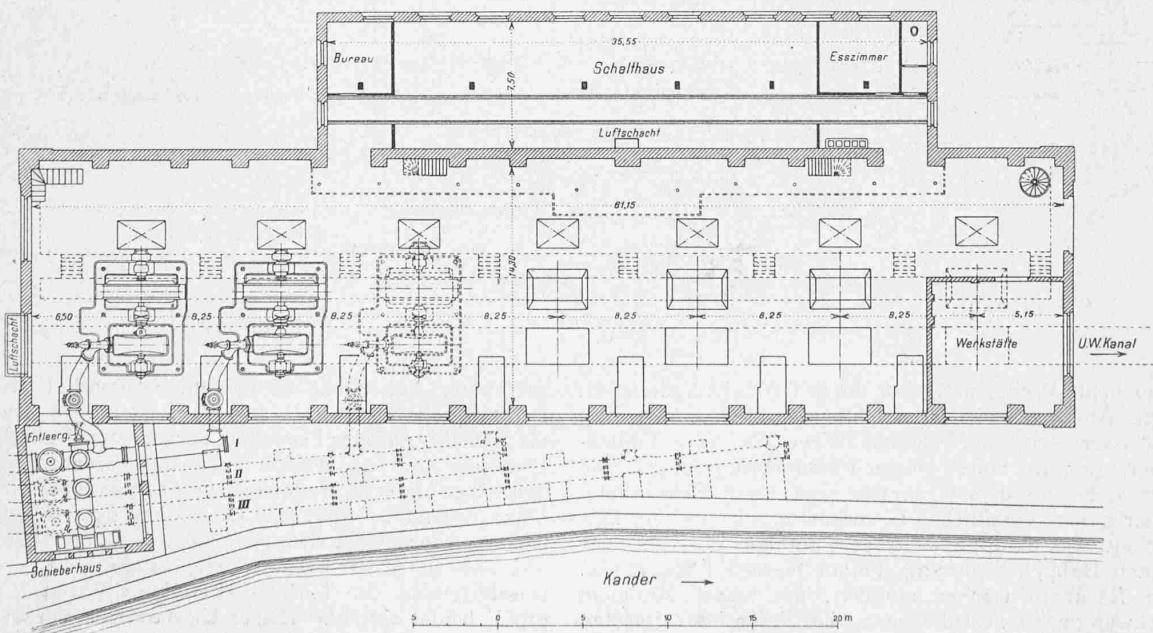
Grundriss der Zentrale des Elektrizitätswerks Kandergrund. — Maßstab 1 : 400.
